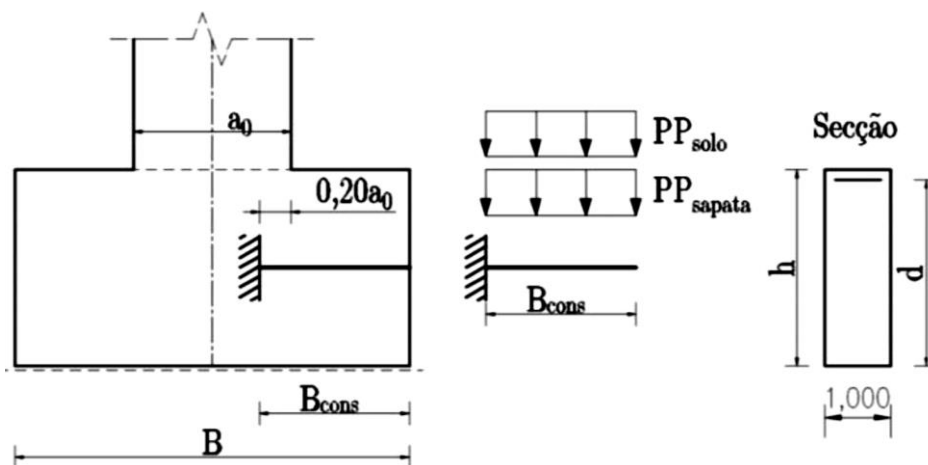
Modelo de cálculo das armaduras da face superior na direção X
